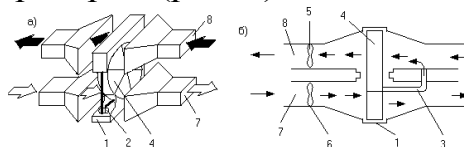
Общий вид и разрез вращающегося теплоутилизатора: 1) корпус; 2) двигатель; 3) камера продувки; 4) ротор с насадкой; 5, 6) вентиляторы (вытяжной и приточный); 7, 8) приточный и вытяжной воздуховоды
